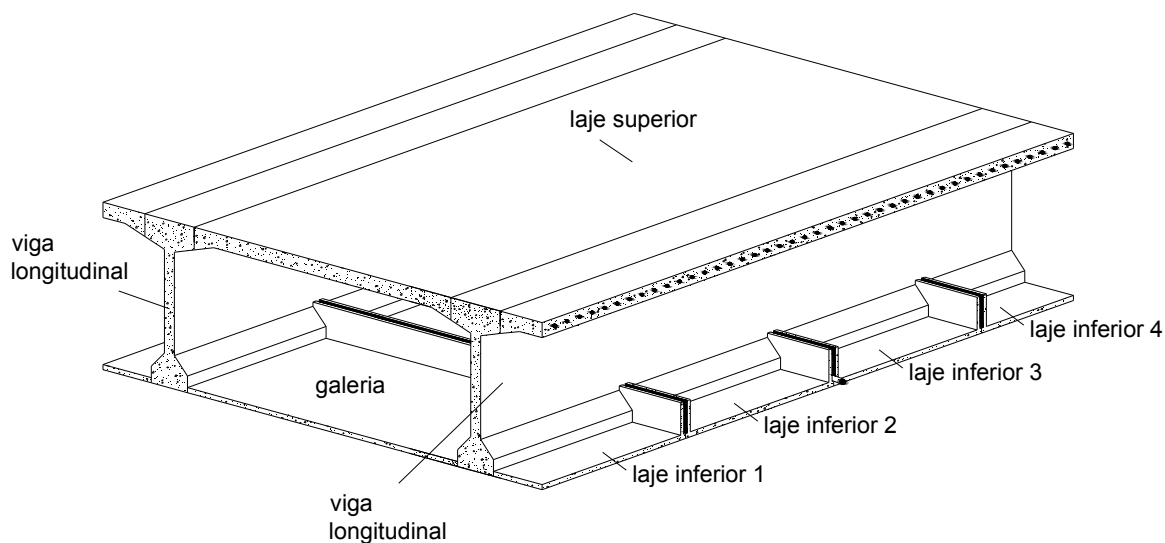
Desenho esquemático de uma galeria típica da Plataforma Superior
